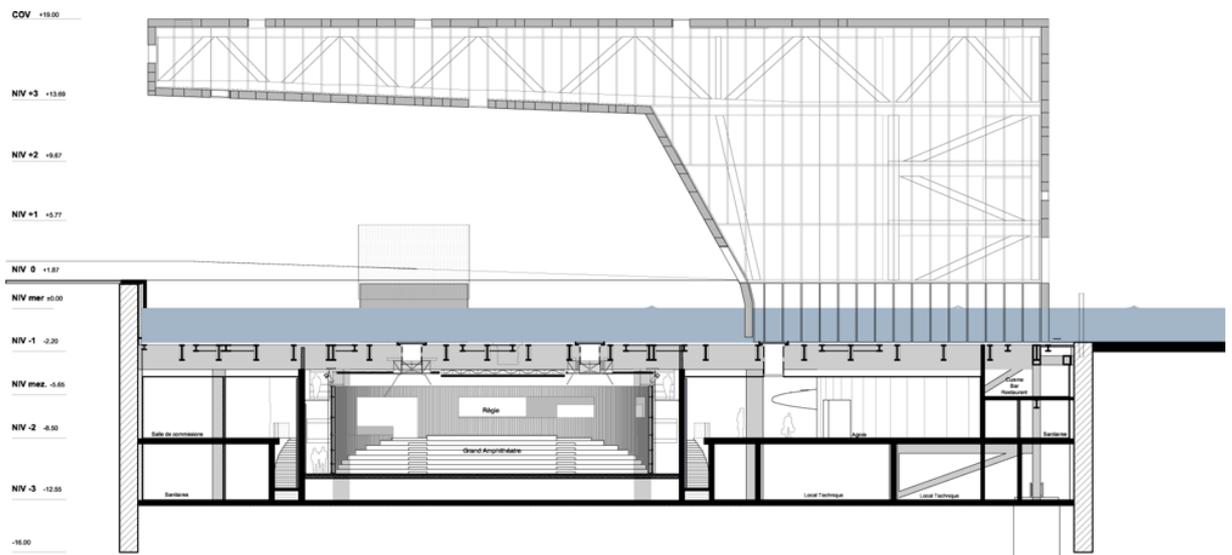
représente les vues en plan des répartitions des espaces par niveau et représente une coupe sur passerelles périphérique en façade
